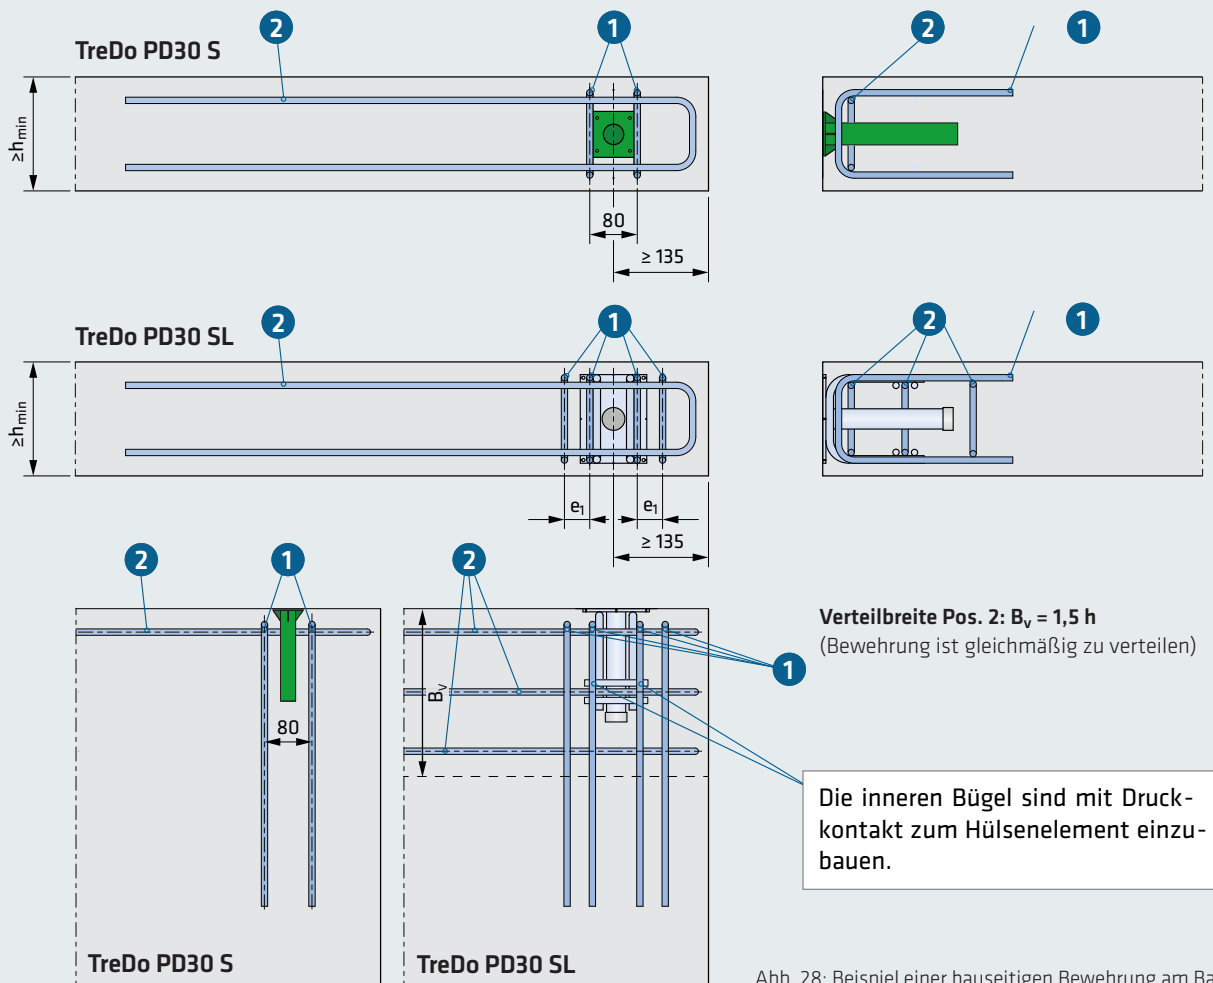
Beispiel einer bauseitigen Bewehrung am Bauteilrand
